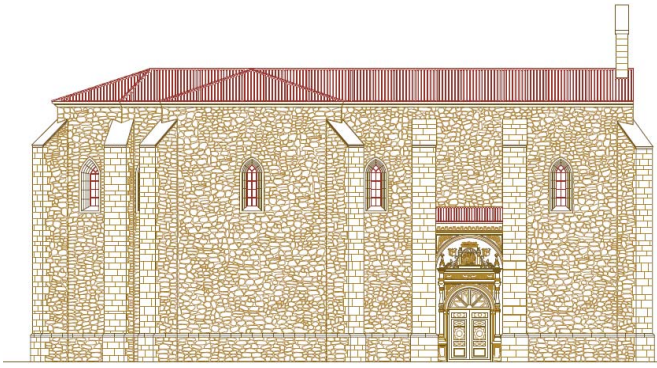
Reconstrucción de la Iglesia de la Piedad. Alzado Principal. 2010. Dibujo de Mireya Ibarra Pérez
